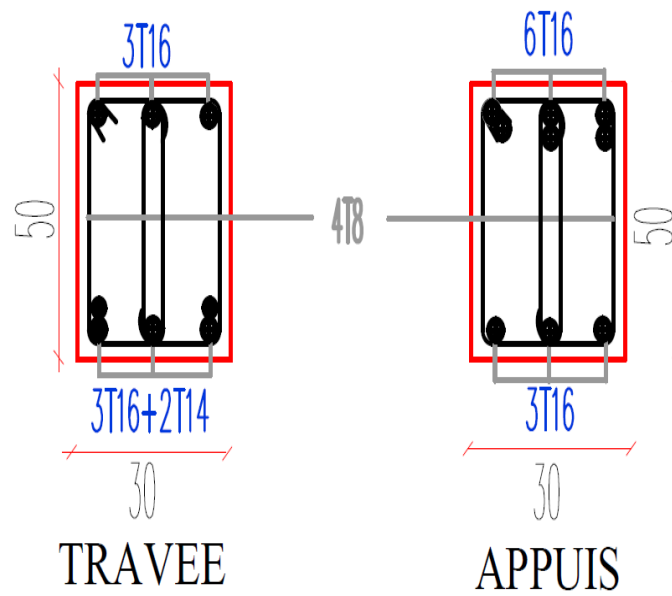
Schéma de ferrailage des poutres principales d'étage courant.
